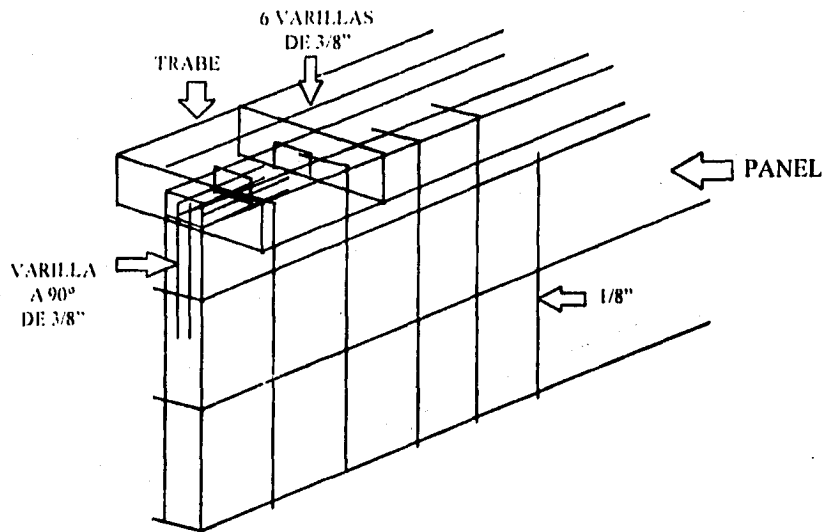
Armado de la trabe y colocación de los ángulos.
